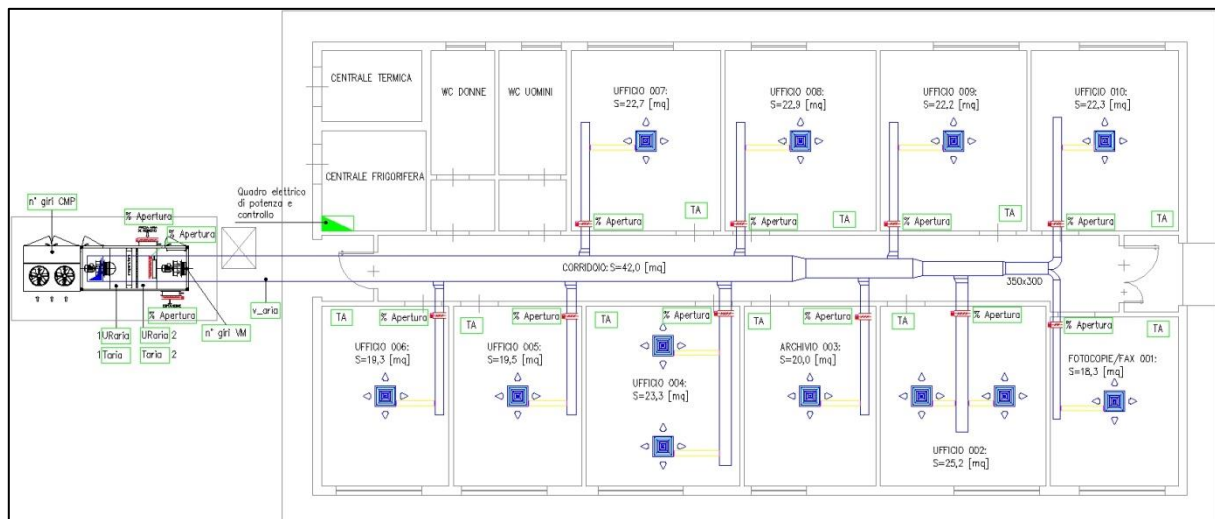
Planimetria del sistema edificio-impianto modellato
